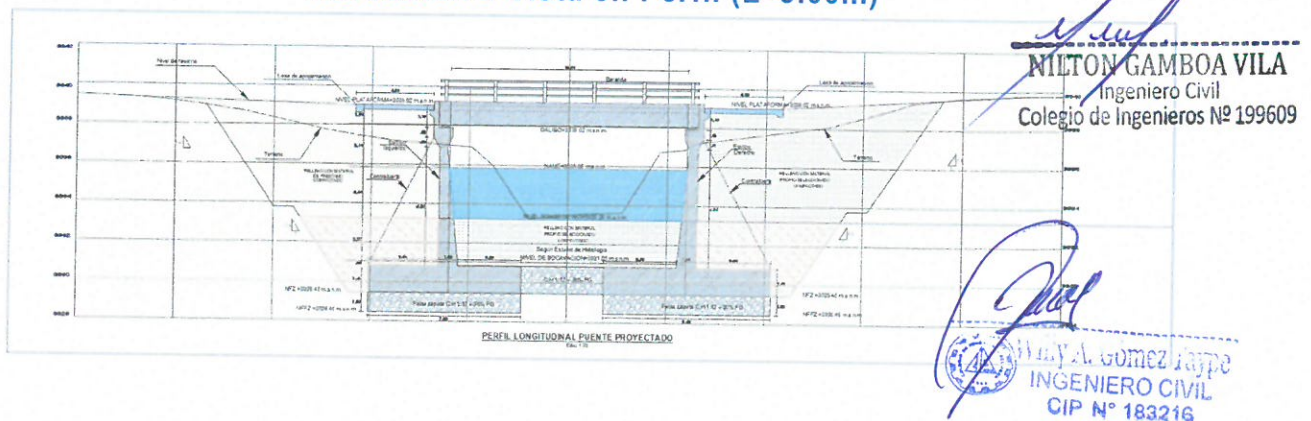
Vista de Ancho total del puente (S=6.0m)
